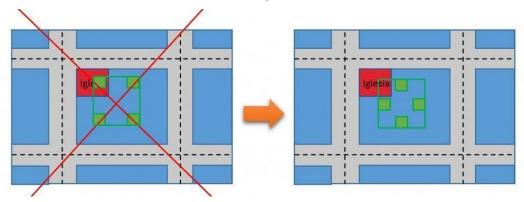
Vista en planta edificio Citicorp Center Fuente: www.theaiatrust.com
